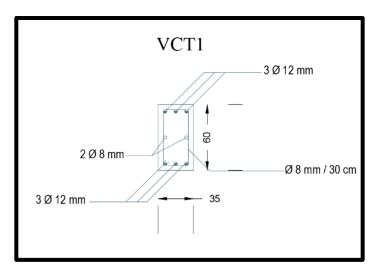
Sección y distribución de acero en viga de cimentación tipo
